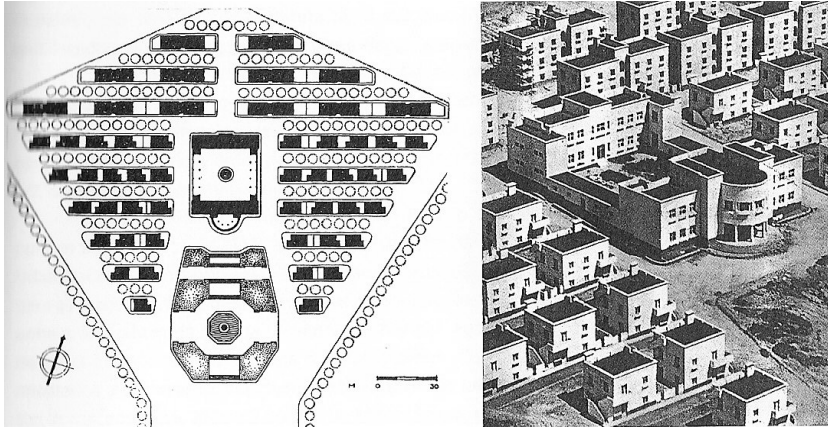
Bairro do Alvito: planta e perspectiva de conjunto
